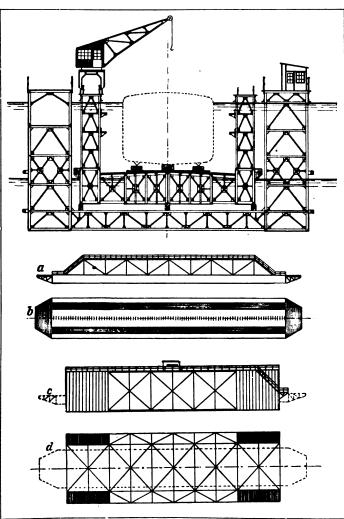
bis 22. Hebewerk mit ausfahrbaren Pontons. a Ansicht, b Grundriß eines Pontons. c Ansicht, d Grundriß eines Hebewerkes.
